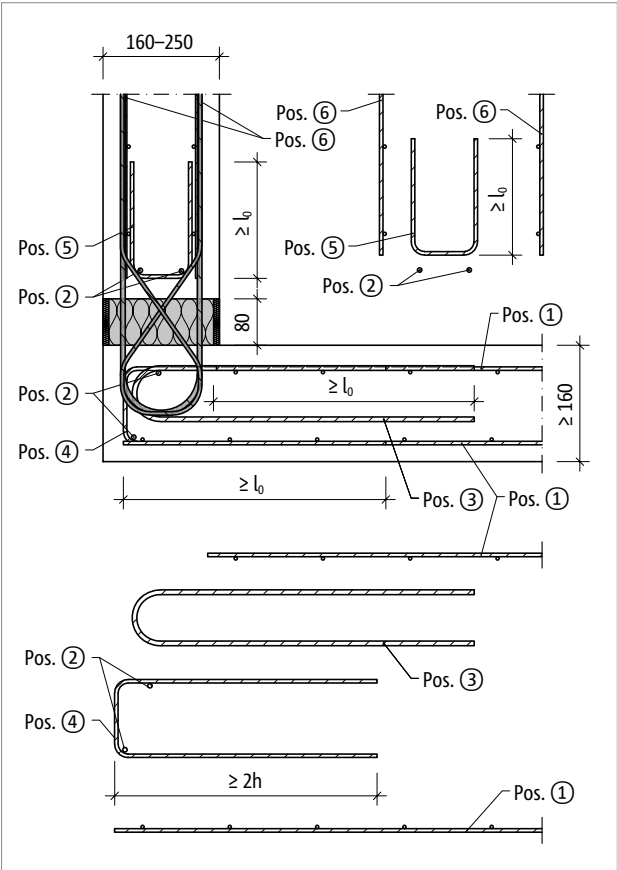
Schöck Isokorb® T type A disposition verticale : Renforcement sur site
